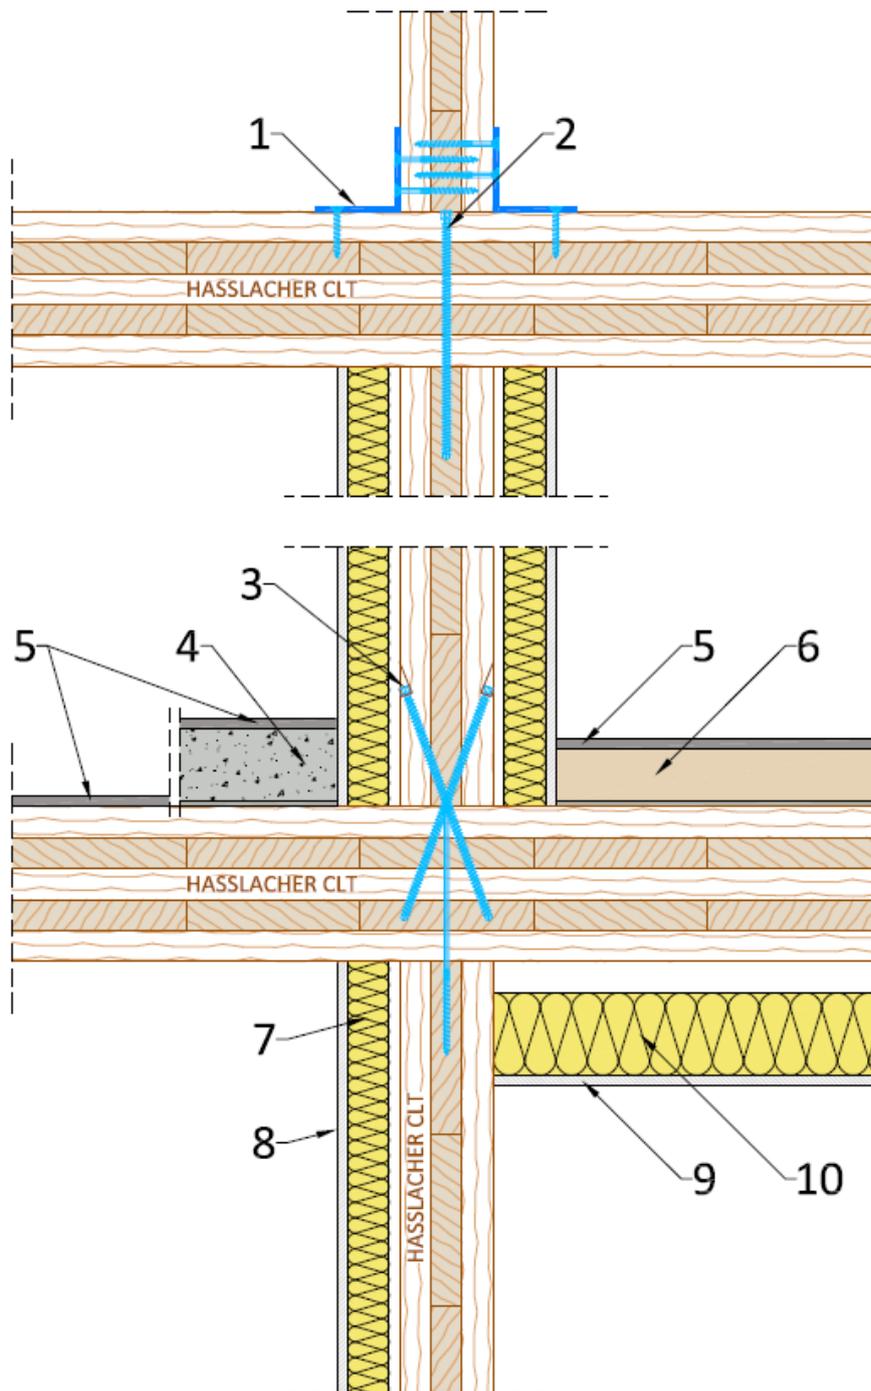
Coupe verticale, assemblage de plancher filant sur mur CLT
